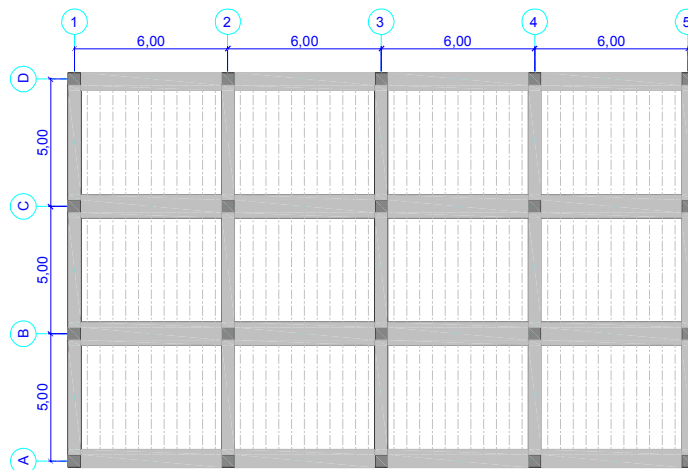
Planta típica del edificio con vigas planas (igual en todos los niveles).
